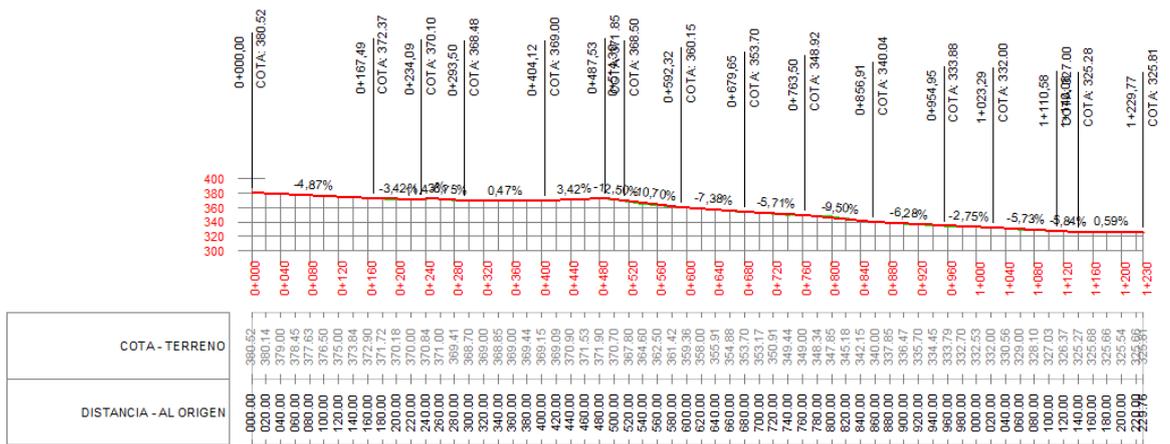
Perfil longitudinal acceso norte monte Salmerón
